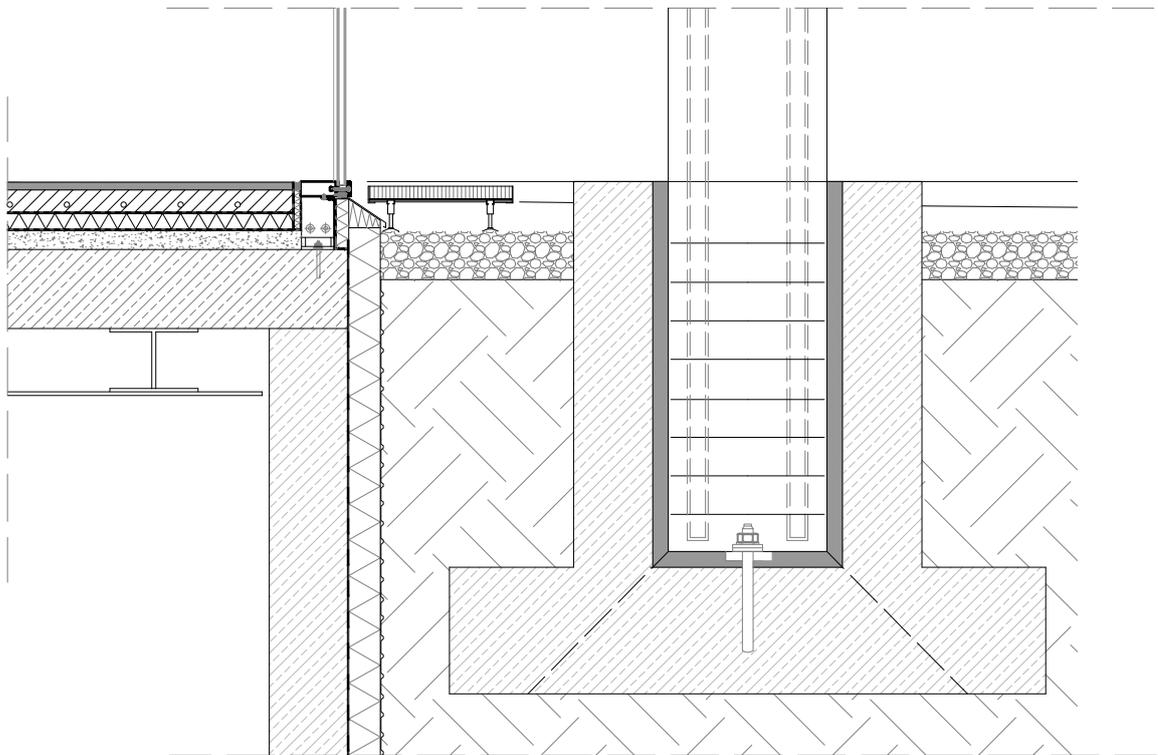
Detaillierte Fassadenschnitt | M: 1:25
